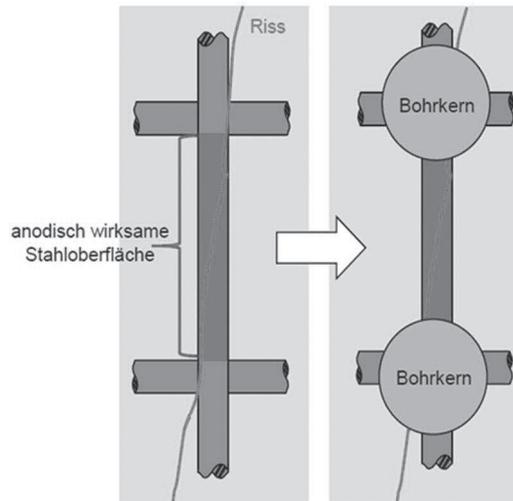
Isolierung eines risskreuzenden, anodisch wirkenden „Bewehrungsstabs“ durch Bohrkernentnahme
